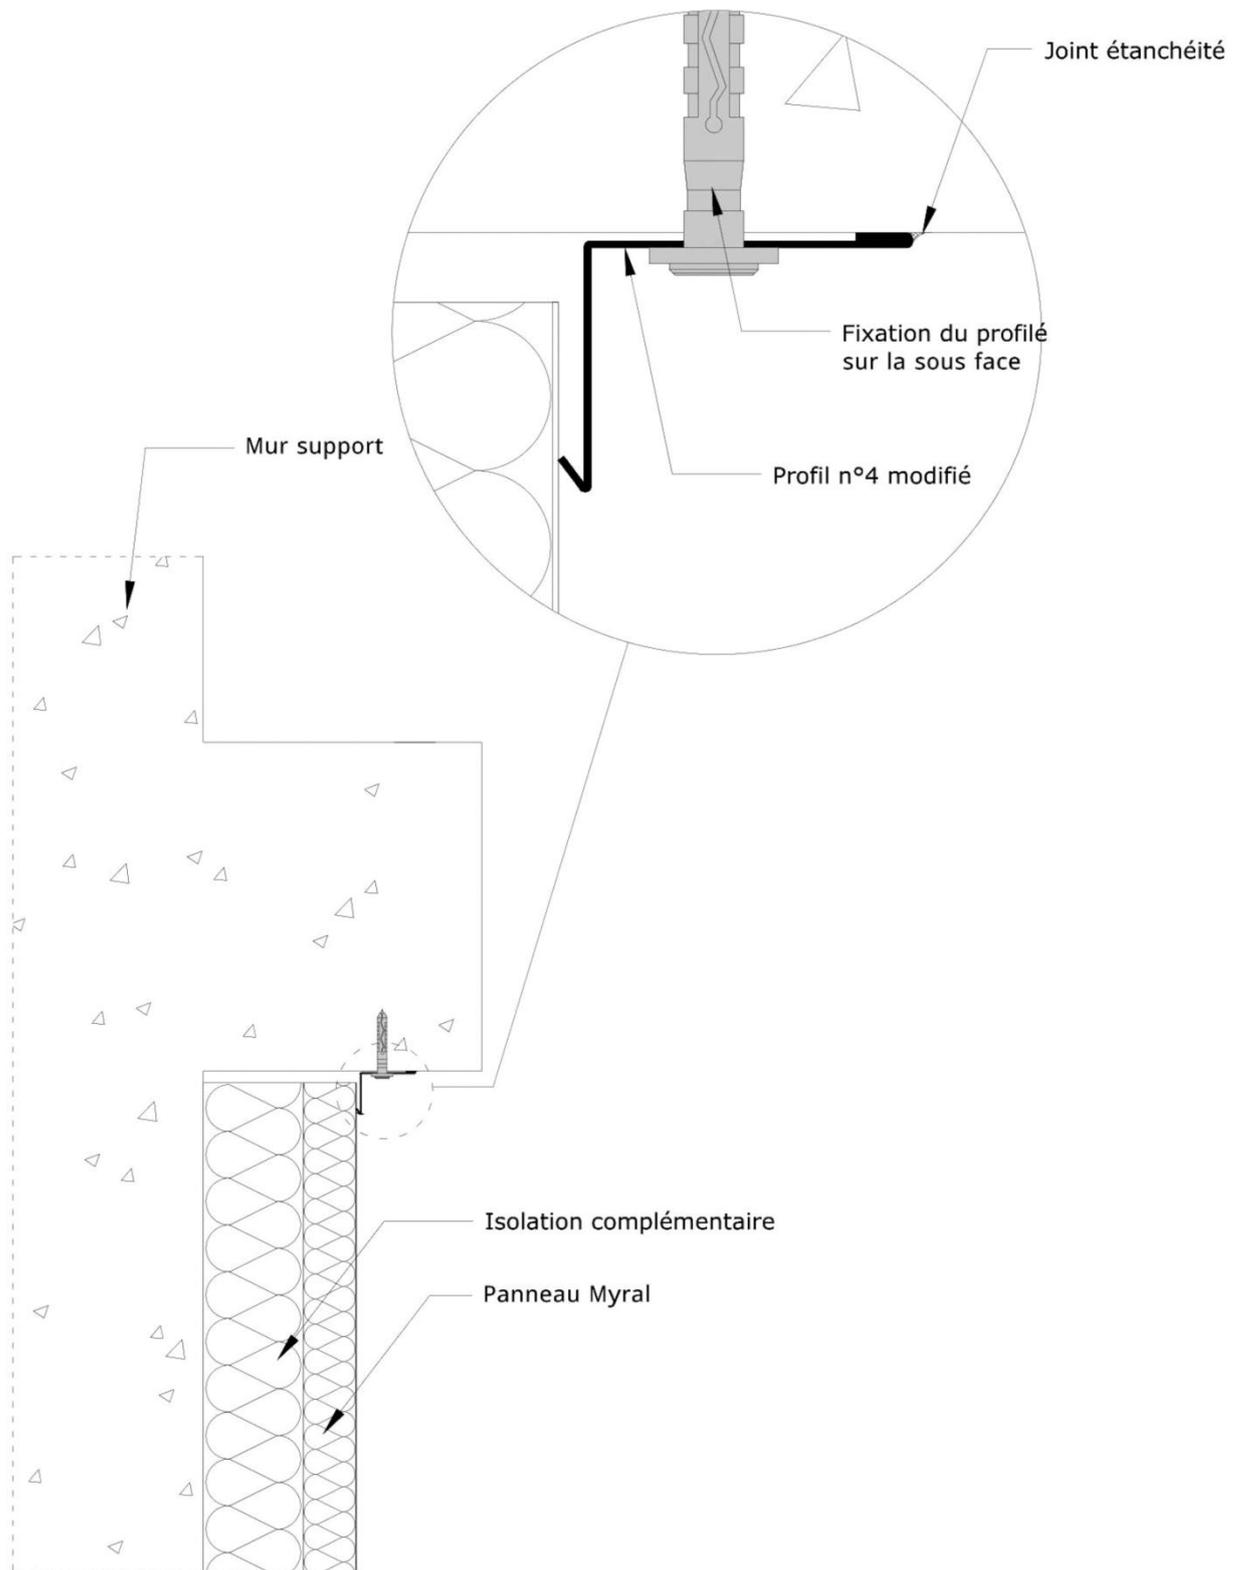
Haut de façade – Pose en bardage simple réseau (coupe verticale)
